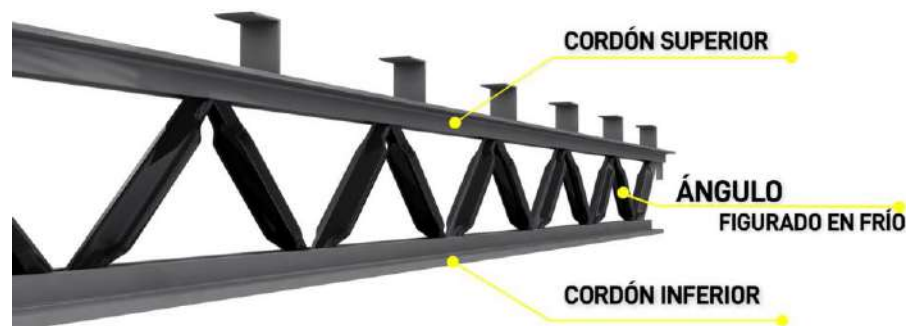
JOIST. Fuente: (VIGA-TEC,2021)
